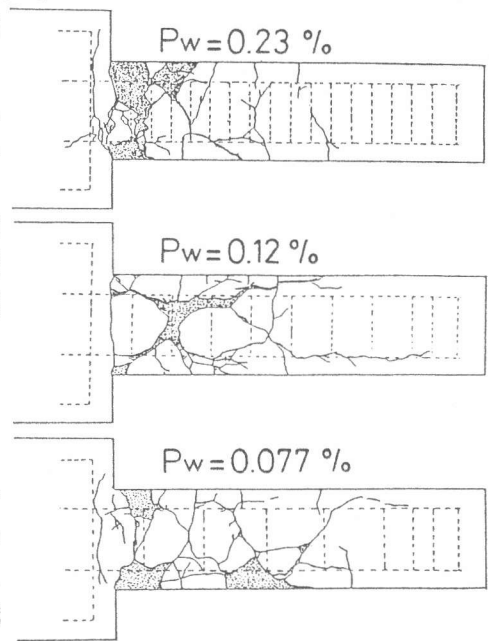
ひびわれ状況(帯鉄筋比の影響)
